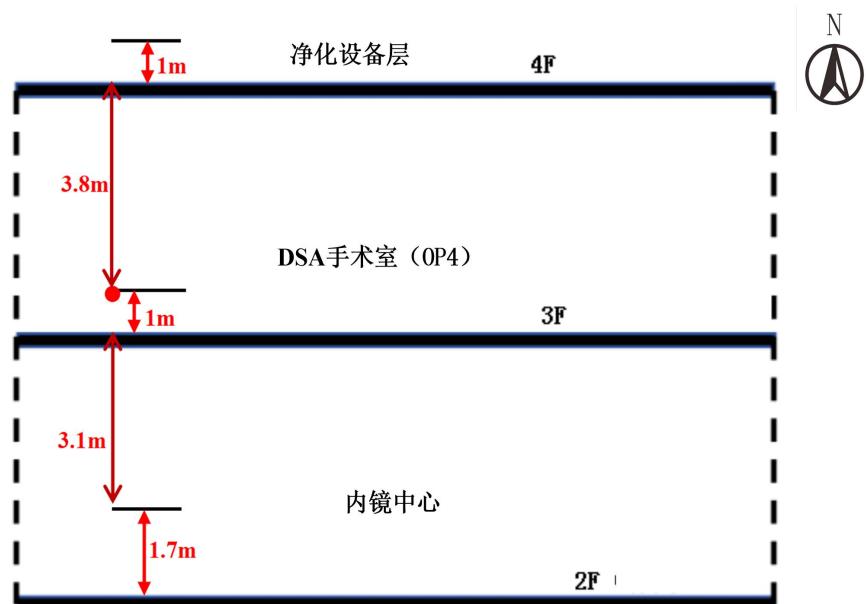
(b) 本项目 DSA 手术室 (OP4) 平面辐射屏蔽设计剖面图
